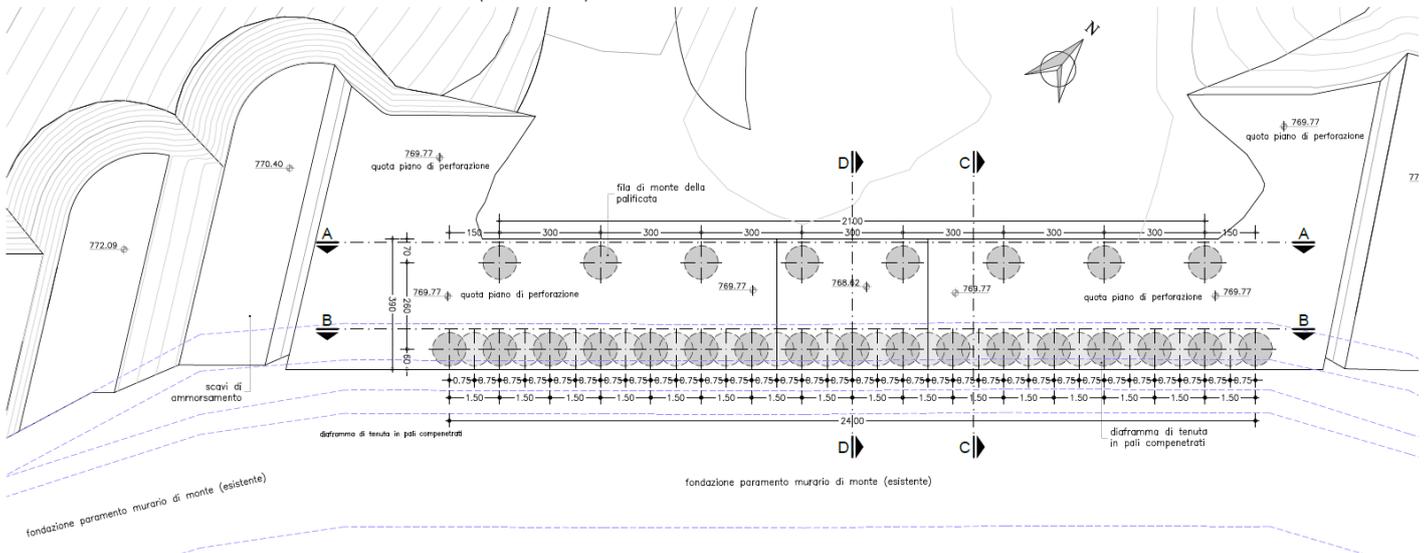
pianta palificata di fondazione dei conci centrali del manto di tenuta e di rinforzo in c.a. del paramento di monte.
